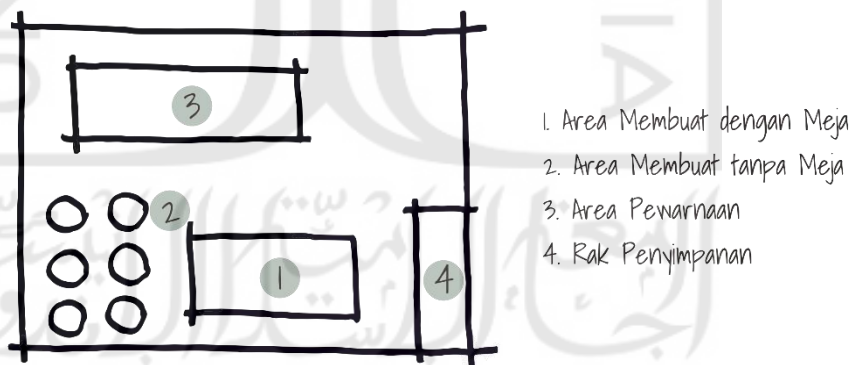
Ilustrasi *Layout Ruang Workshop Batik
